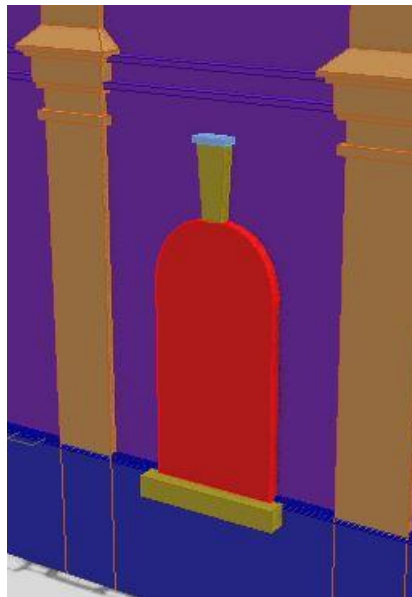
Vista detalle de los ornamentos de las ventanas frontales de la planta baja.
